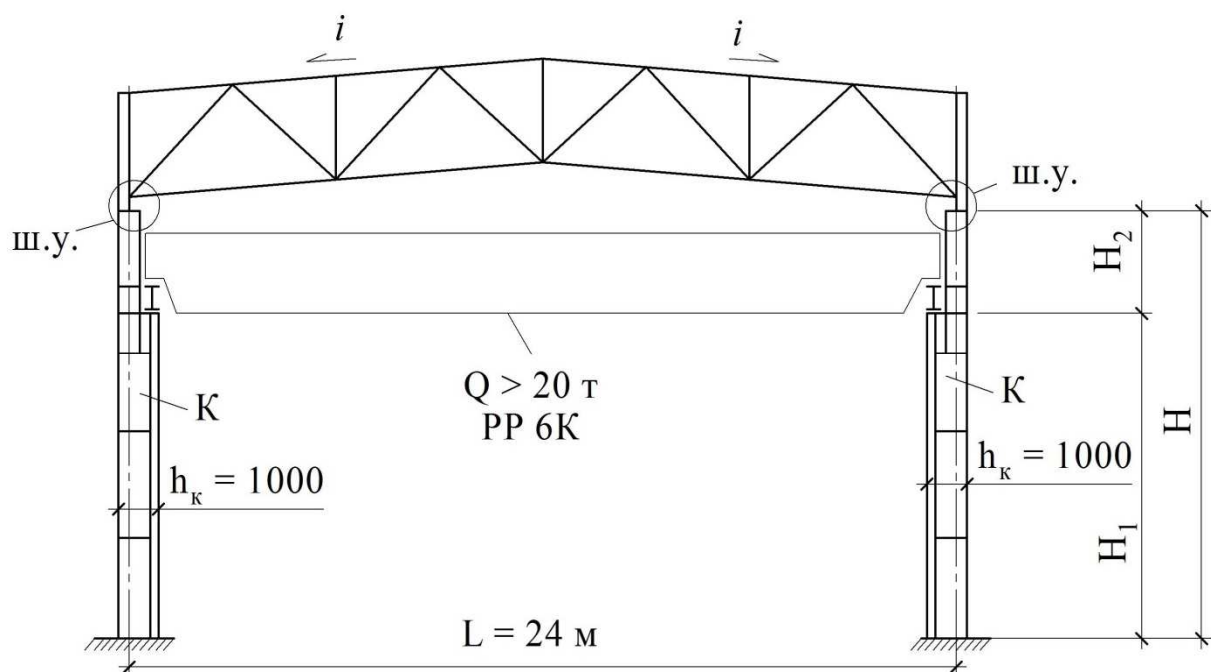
Однопролетная поперечная рама с верхними шарнирными узлами и мостовым краном грузоподъемностью  $Q > 20$  т и ступенчатыми колоннами
